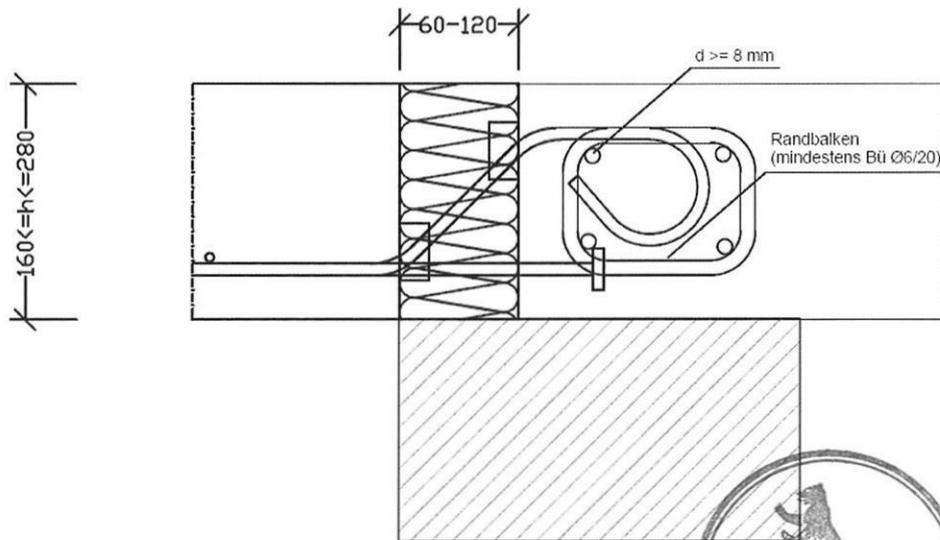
Ausführung mit abgebogenem Querkraftstab
